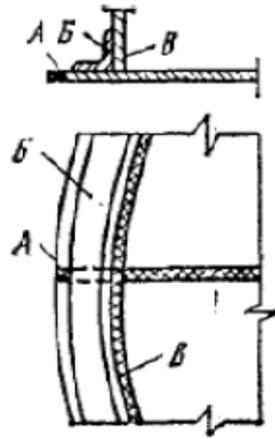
Продольная трещина А в сварном стыковом соединении окрайки днища, не доходящая до уторного уголка Б; в резервуарах без уторного уголка- до корпуса В
